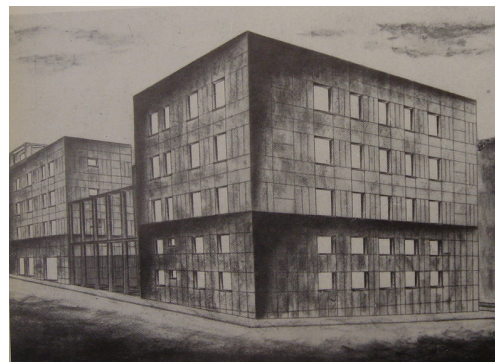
Palazzo dell'I.N.A. ad Enna: II° progetto (stesura definitiva 1939-40)-prospetto posteriore.
